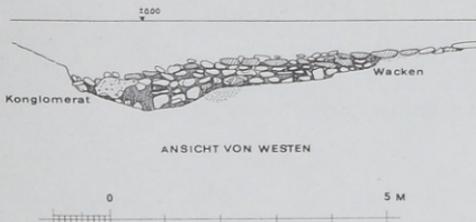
Bau II. Ansicht von Westen, M 1:100.
